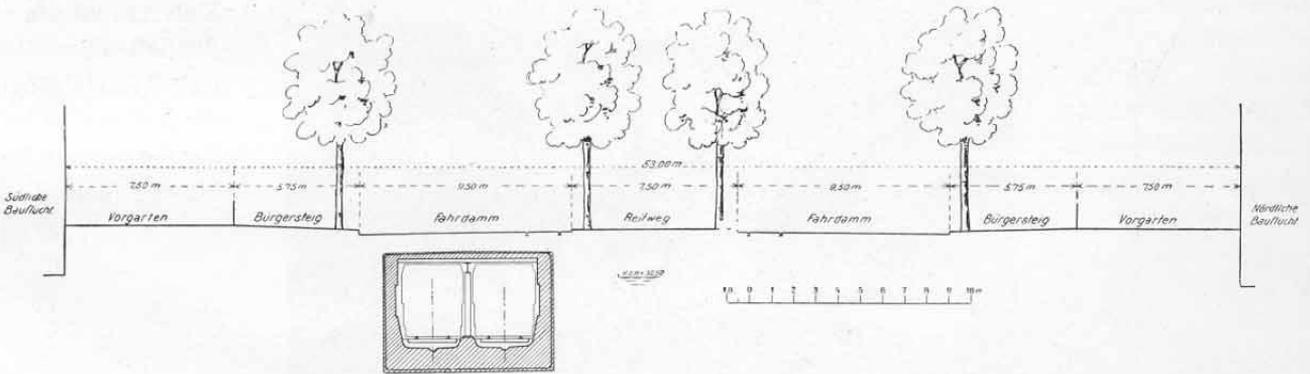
Querschnitt durch den Kurfürstendamm mit normalem Tunnel.
